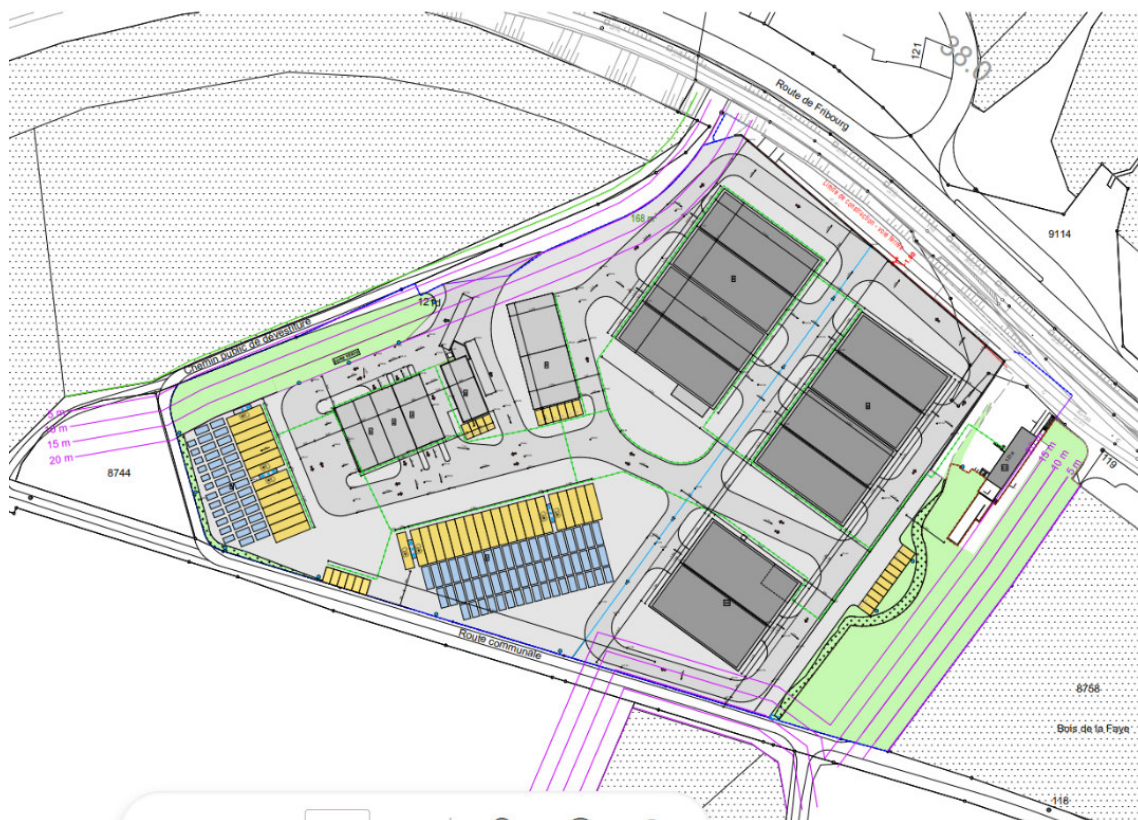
Plan d'implantation du projet architectural (Source : projet architectural)
